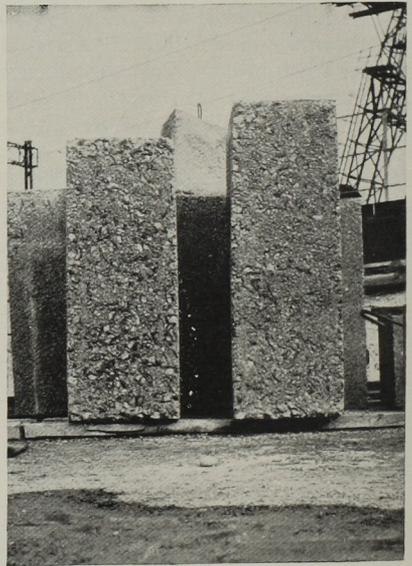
Wölbquader aus Beton mit Contexbehandlung für die Lorrainebrücke in Bern
